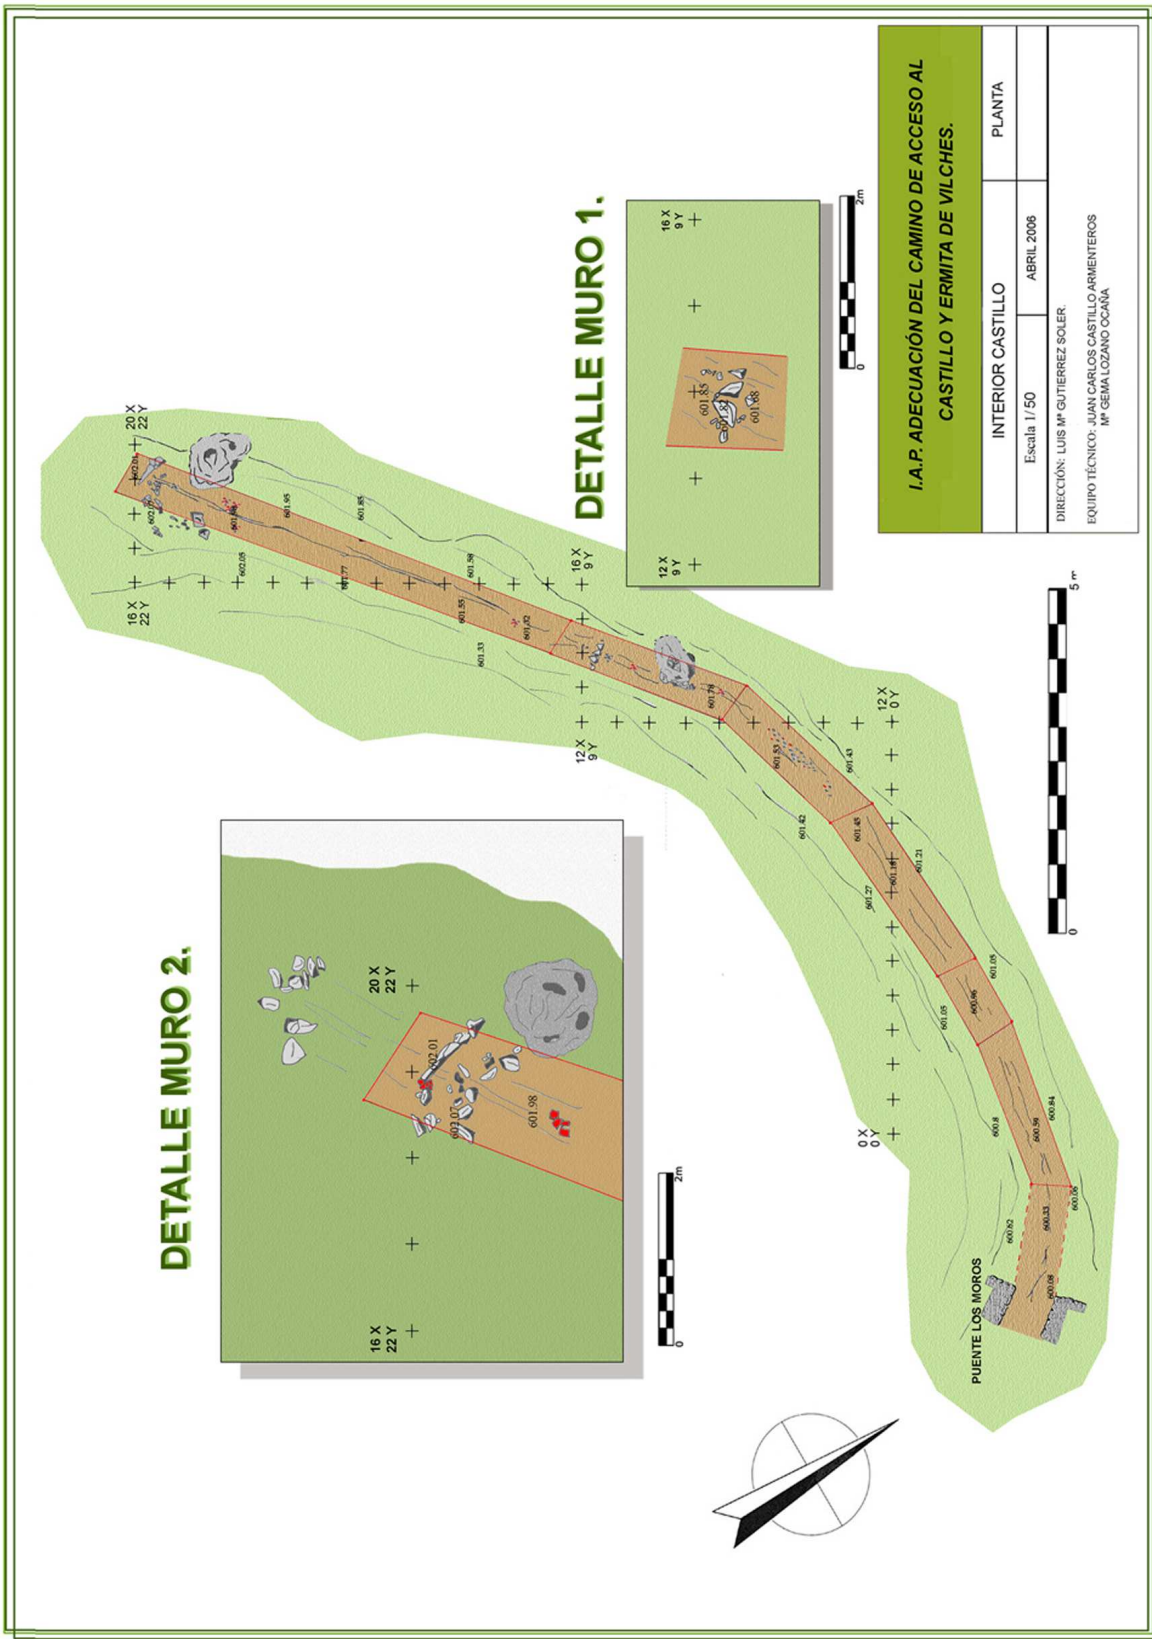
Planta del camino en el interior del recinto defensivo. Detalle de los cimientos de las construcciones documentadas.
